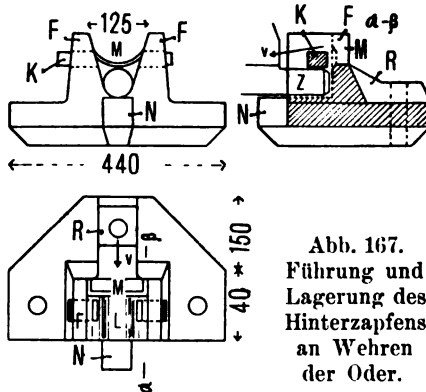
Führung und Lagerung des Hinterzapfens an Wehren der Oder.
